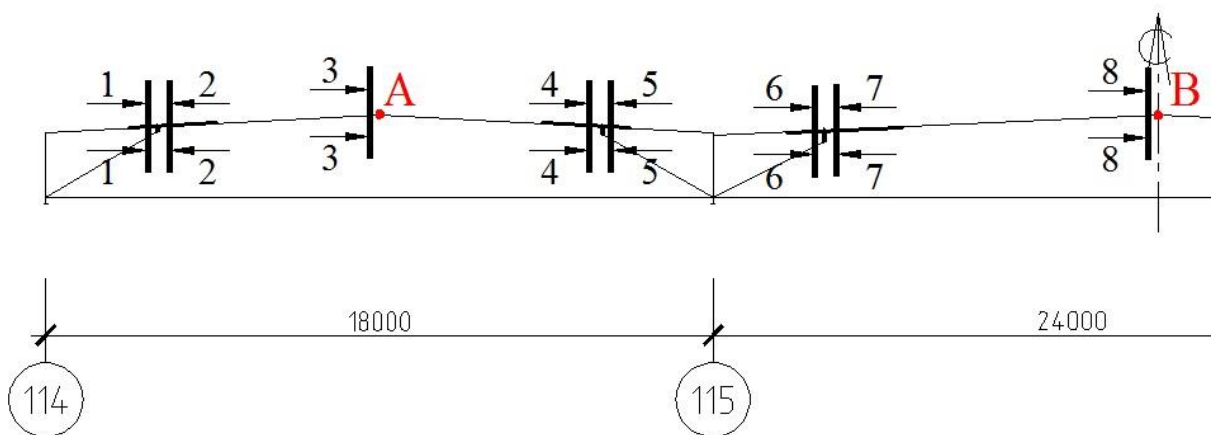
Схема расчетных сечений элементов трехпролетной конструкции покрытия
